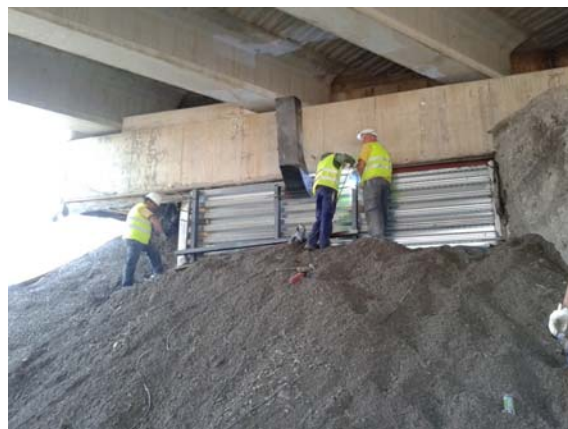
Relleno bajo losa de transición con hormigón en masa autocompactable. Detalle del encofrado y bebedero en el frente de estribo
